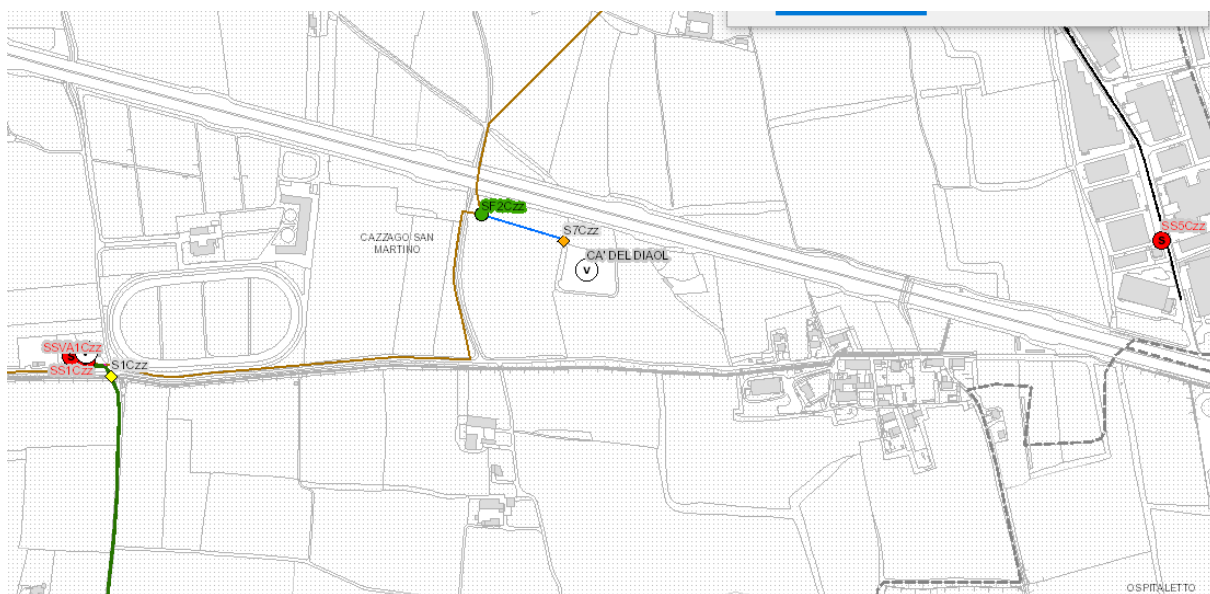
Stralcio planimetrico rappresentante la rete fognaria esistente, Comune di Cazzago S.M. – loc. Ca del Diaol
